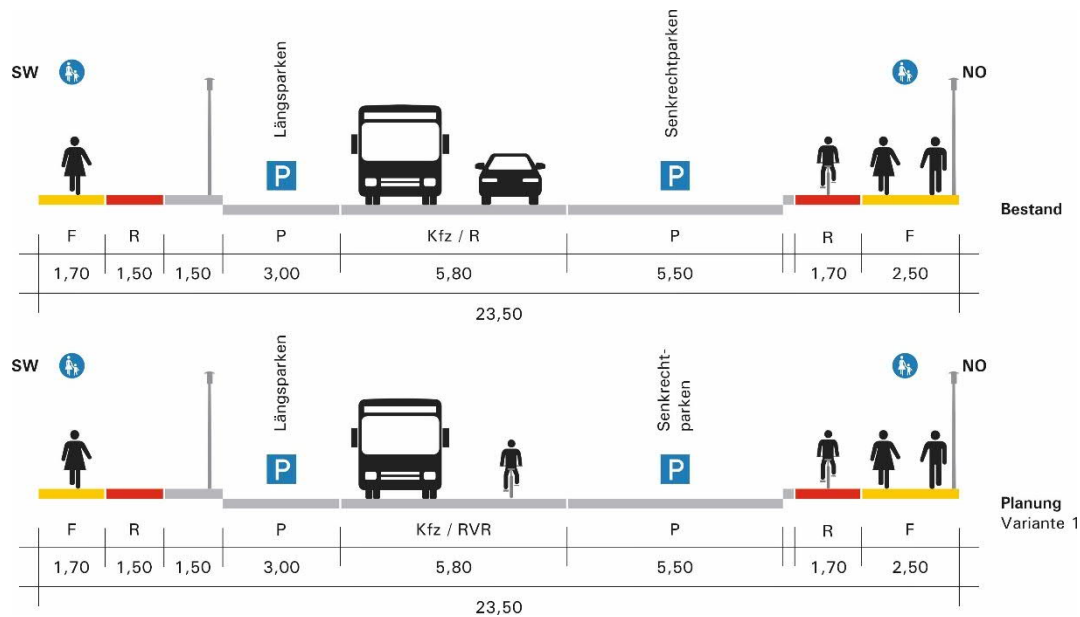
Querschnitt Abschnitt Stormarnstraße (A-14; Bestand und Planung)
